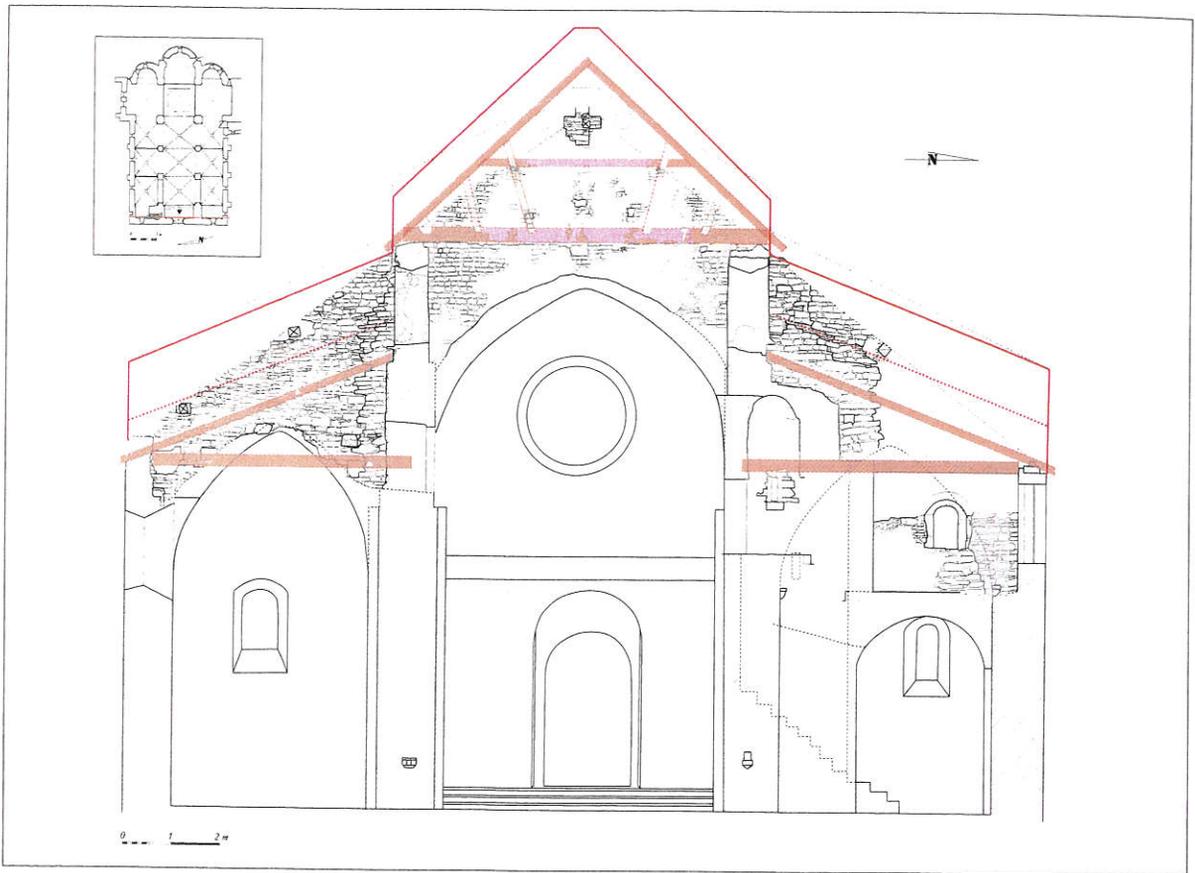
Saint-Lupicin, revers de la façade occidentale, relevé pierre à pierre et proposition de restitution des toitures et du profil de la façade (dessin L. Fiocchi d'après S. Bully et équipe de fouille, APAHJ-UMR ArteHis, Dijon)
